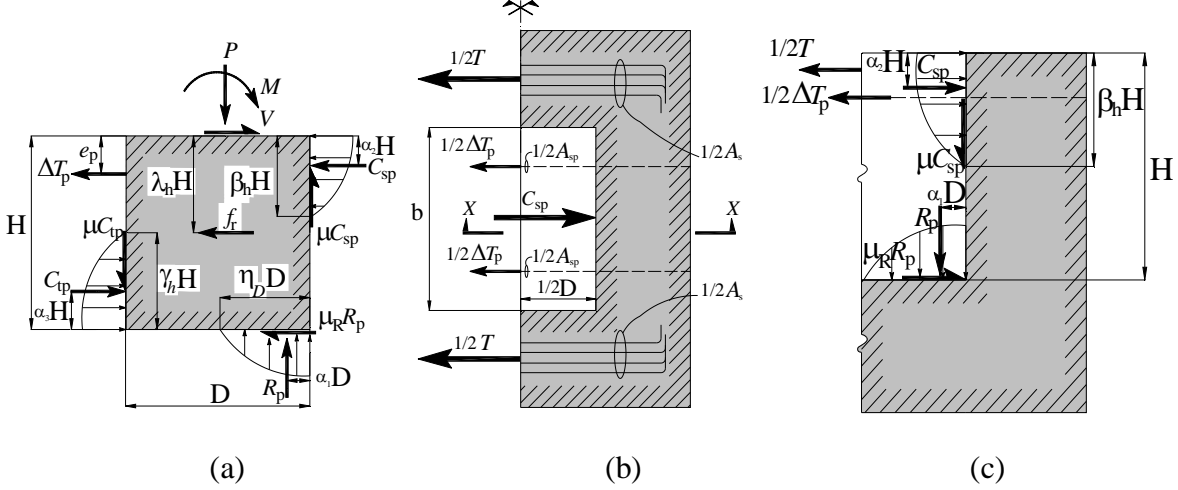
Fuerzas en la cimentación candelero con presfuerzo. a) Reacciones en columna dentro de candelero, elevación, b) Planta cimentación, c) Sección X.X
